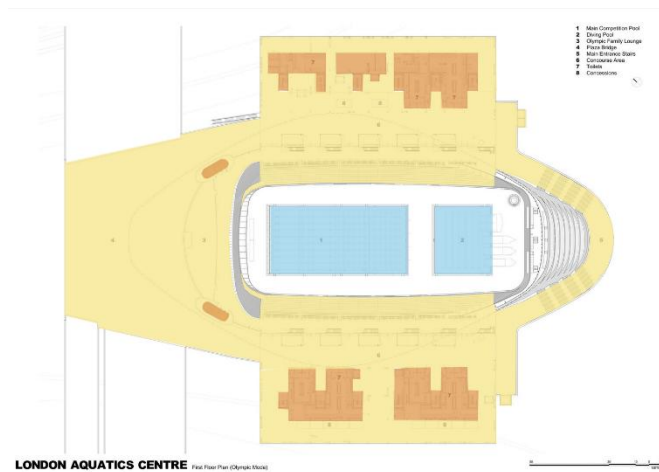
26 Zonasi Ground Floor Plan London Aquatic Centre (Olympic Mode)
